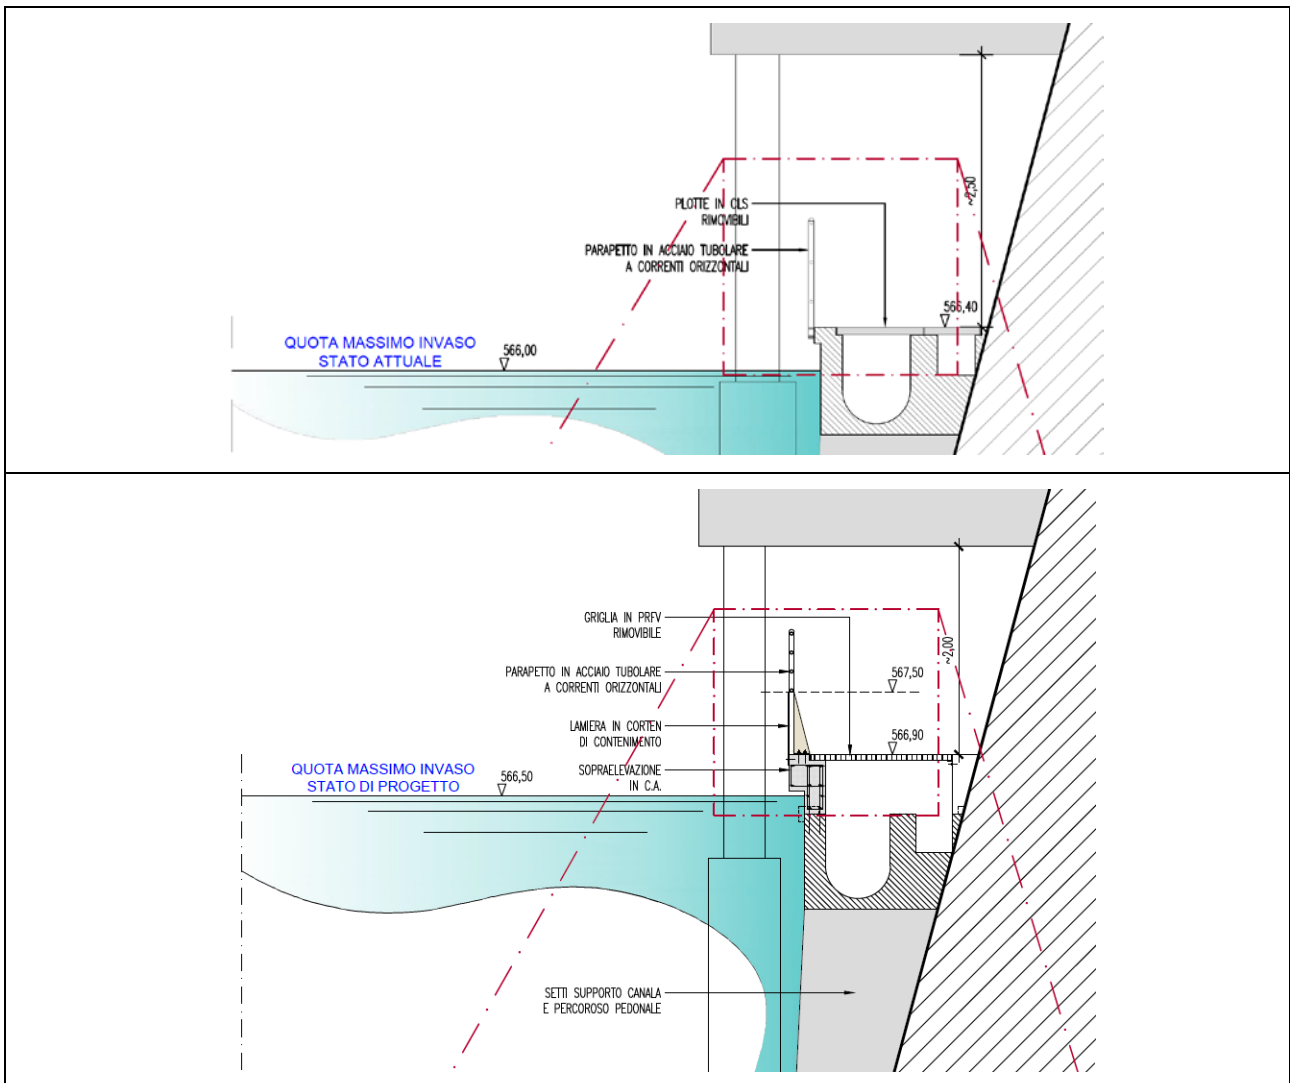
confronto tra stato attuale e proposta di progetto del camminamento sotto la casa di guardia.
